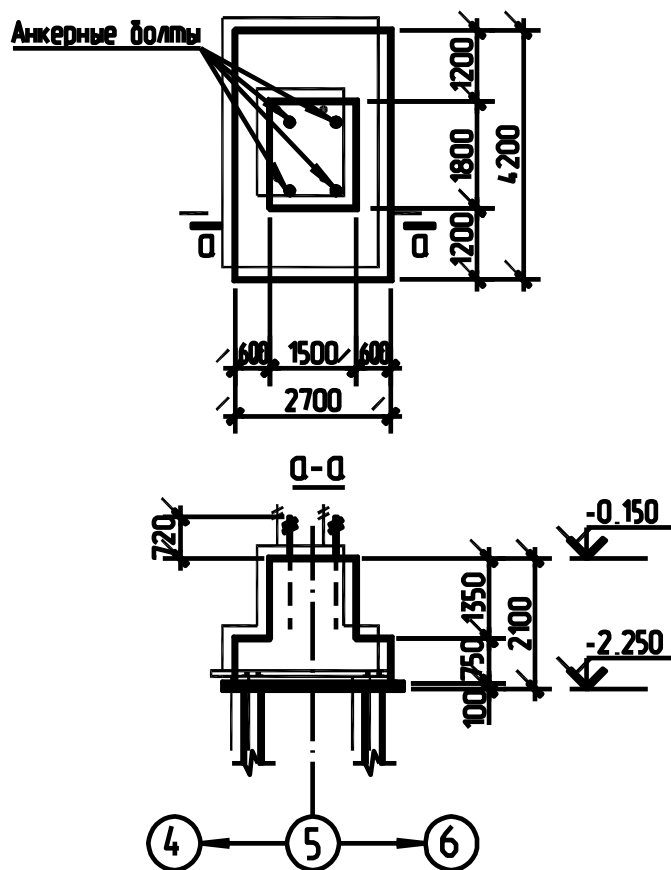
Свайный фундамент под крайнюю колонну
